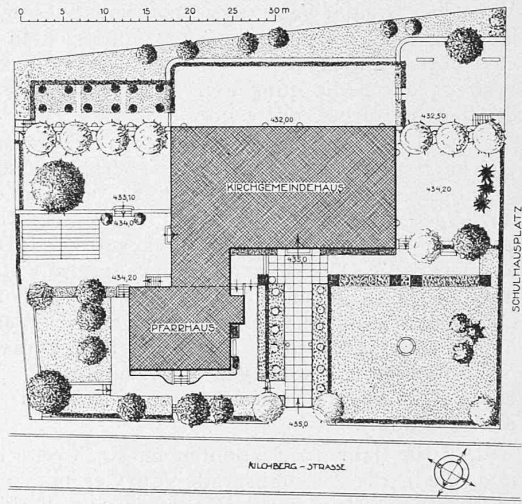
Lageplan vom Kirch-Gemeindehaus Wollishofen. 1 : 800.
